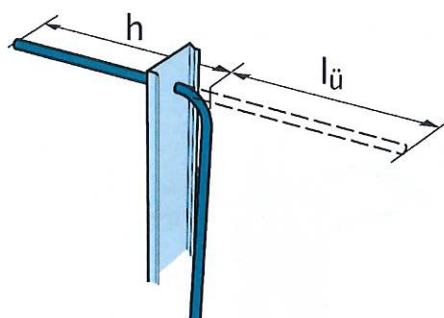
Prętowy zestaw łączący HBT do łączenia elementów żelbetowych
